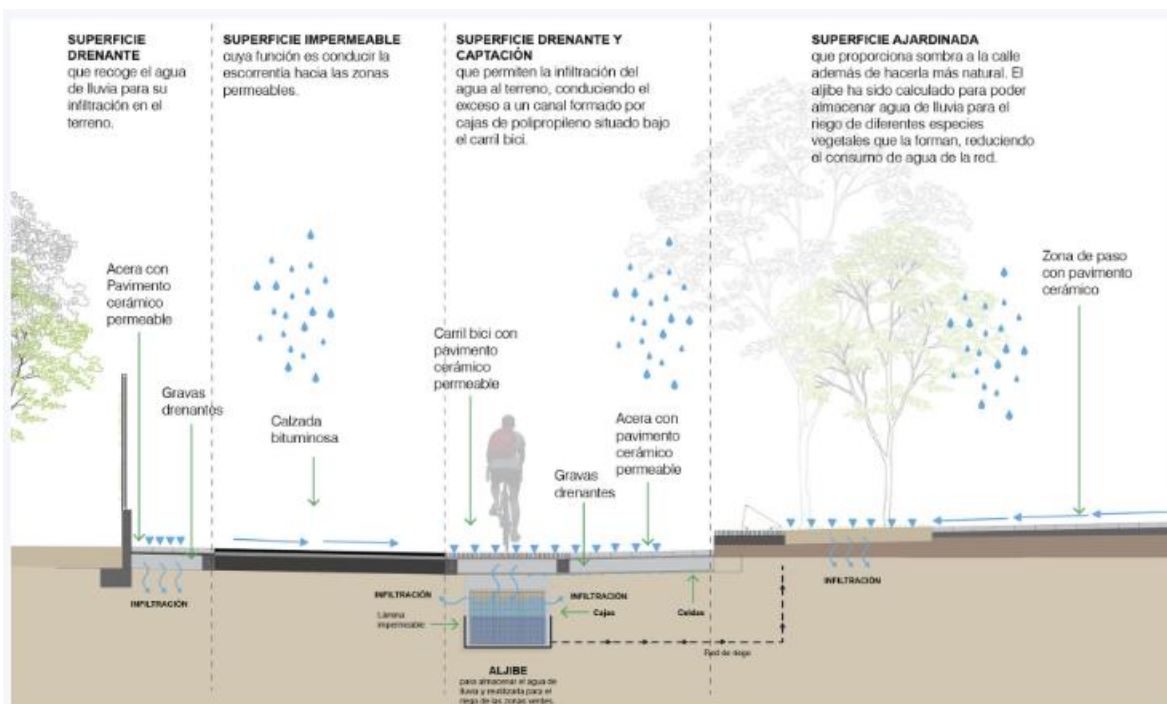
Perfil objetivo vías locales con pavimentos permeables. Fuente: Pavimento cerámico permeable como solución de drenaje sostenible (Mimbrero, D. 2019).
